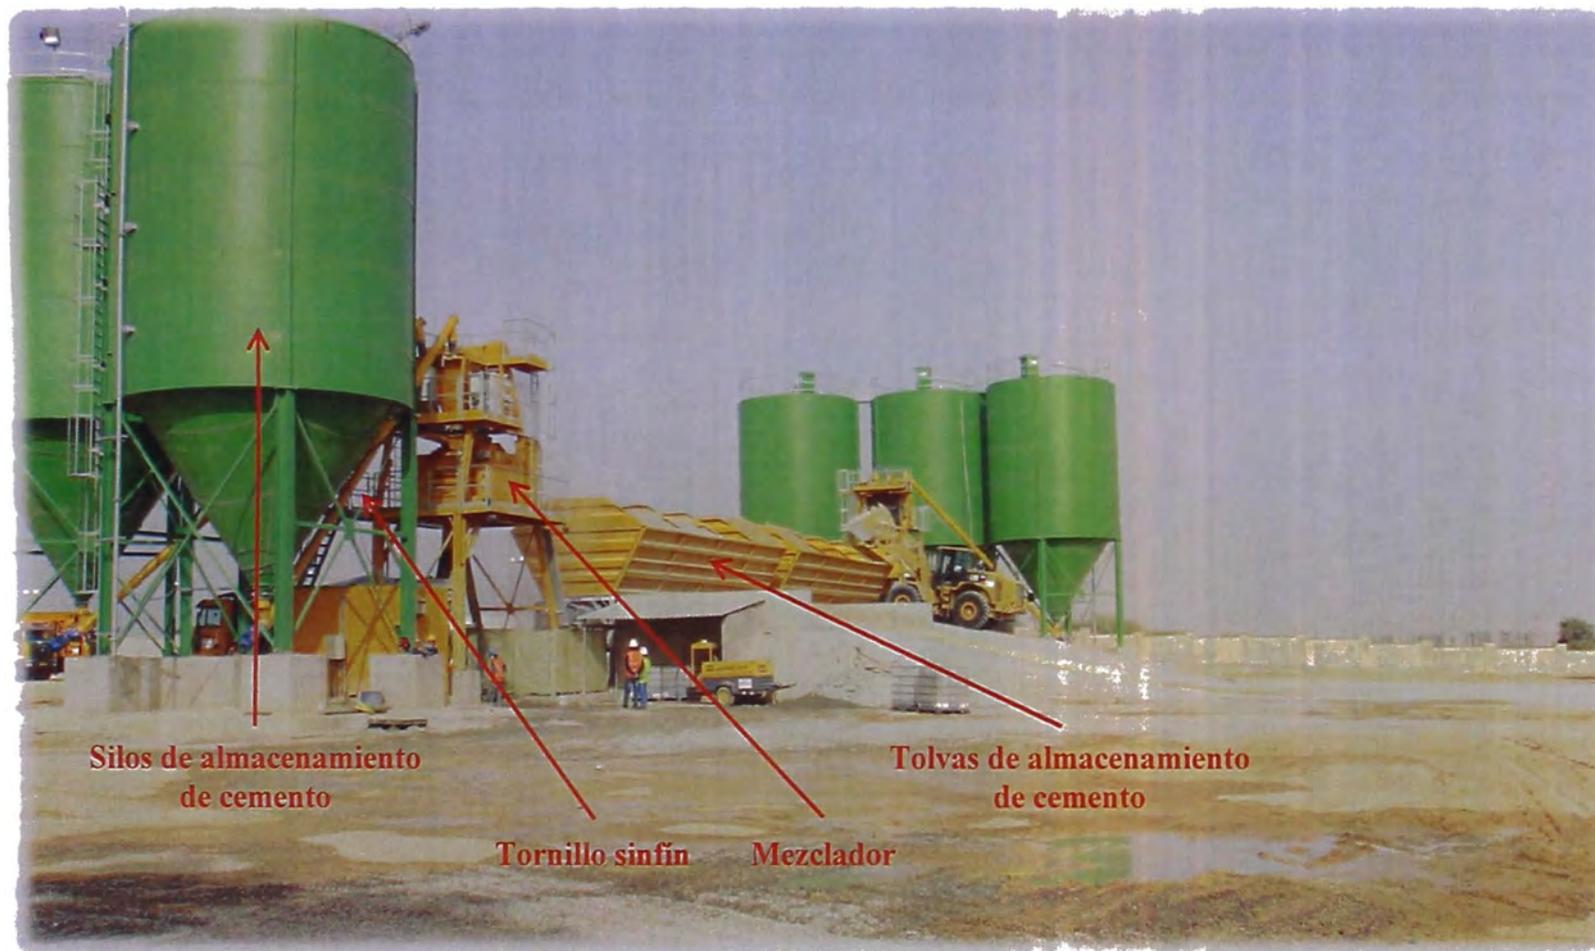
Disposición general de la Planta de Concreto LBCD
